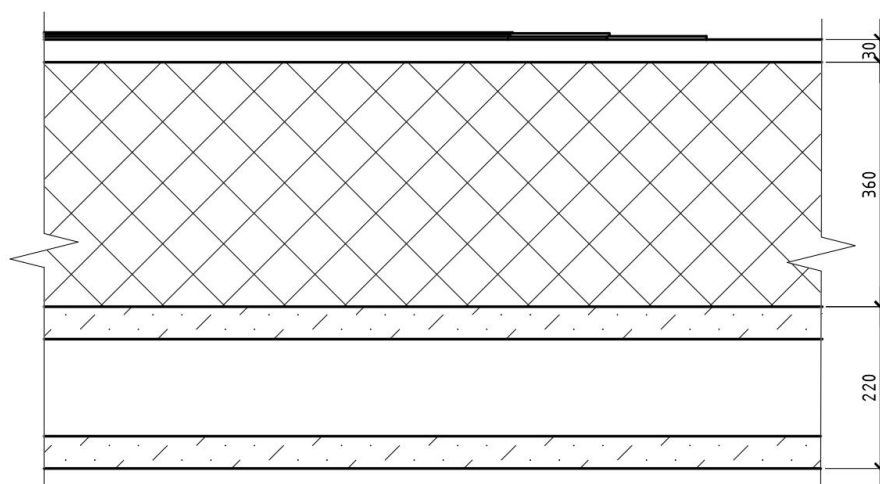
Ескіз перерізу перекриття з прийнятим утеплювачем
